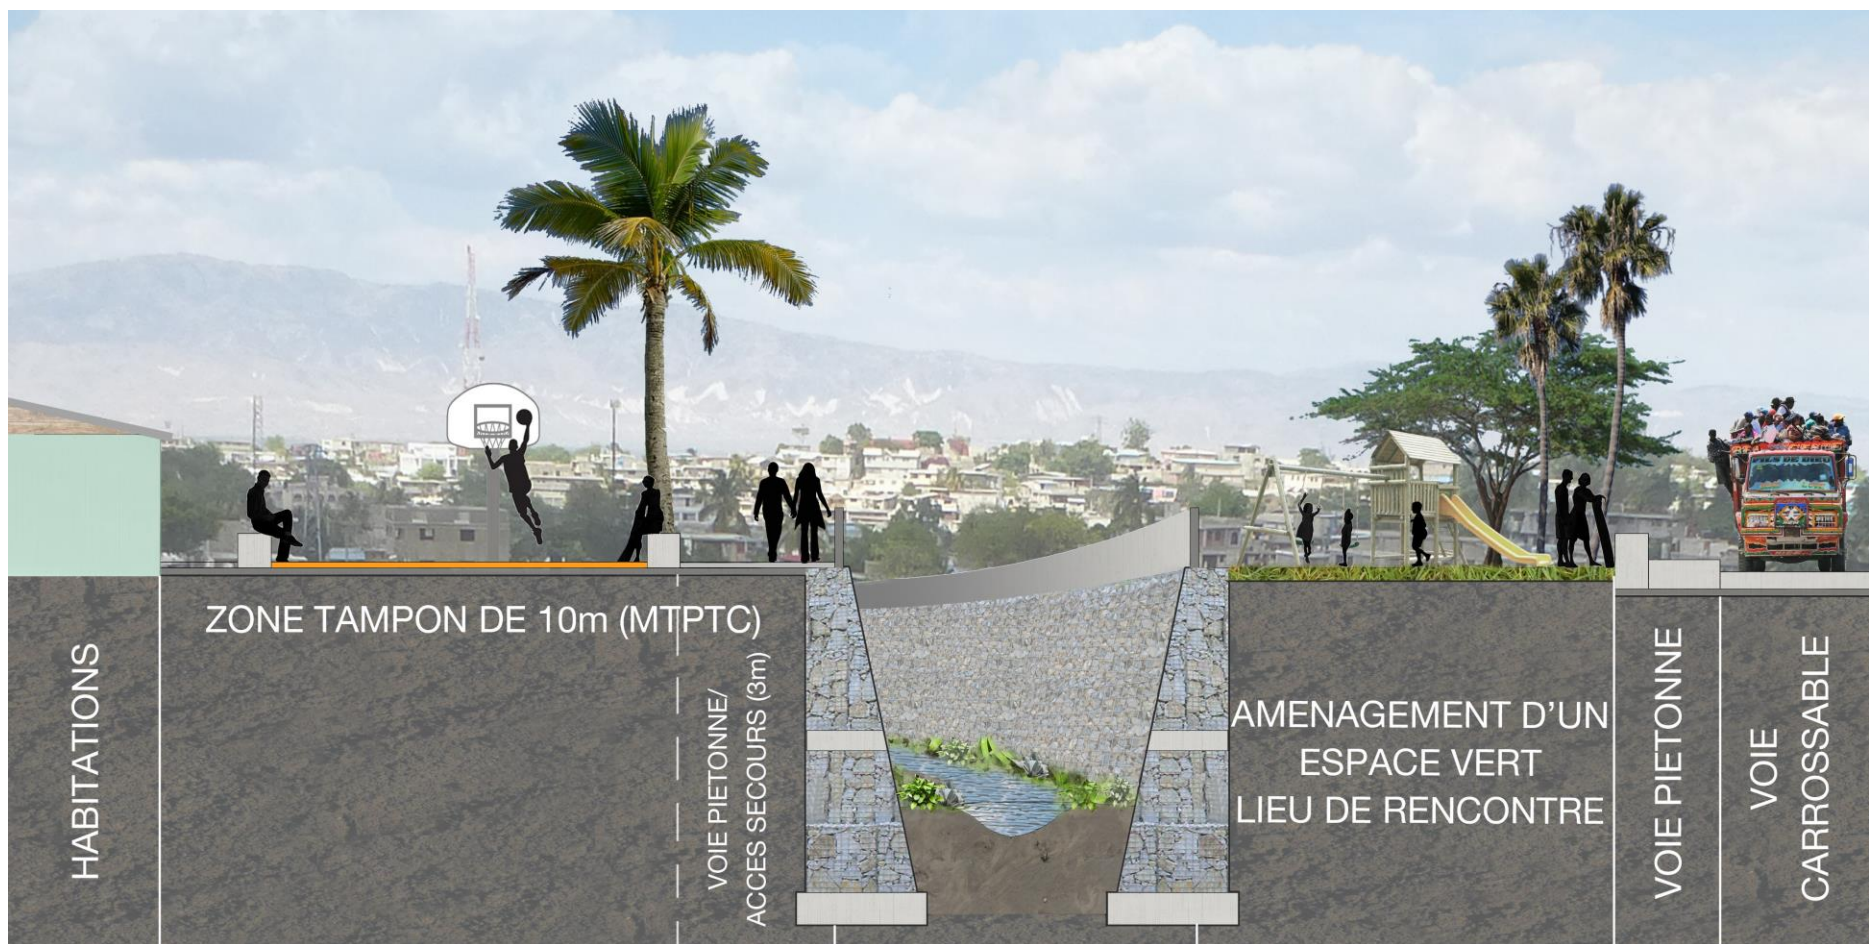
Exemple de coupe sur la ravine Nicolas. La voie carrossable à droite serait la rue Christ Roi
